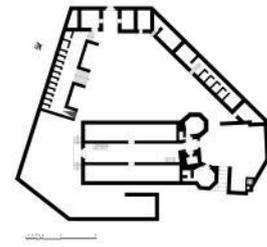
مسقط أفقي للدور العلوي لقلعة لعلع (رسم بمعرفة الباحث)
